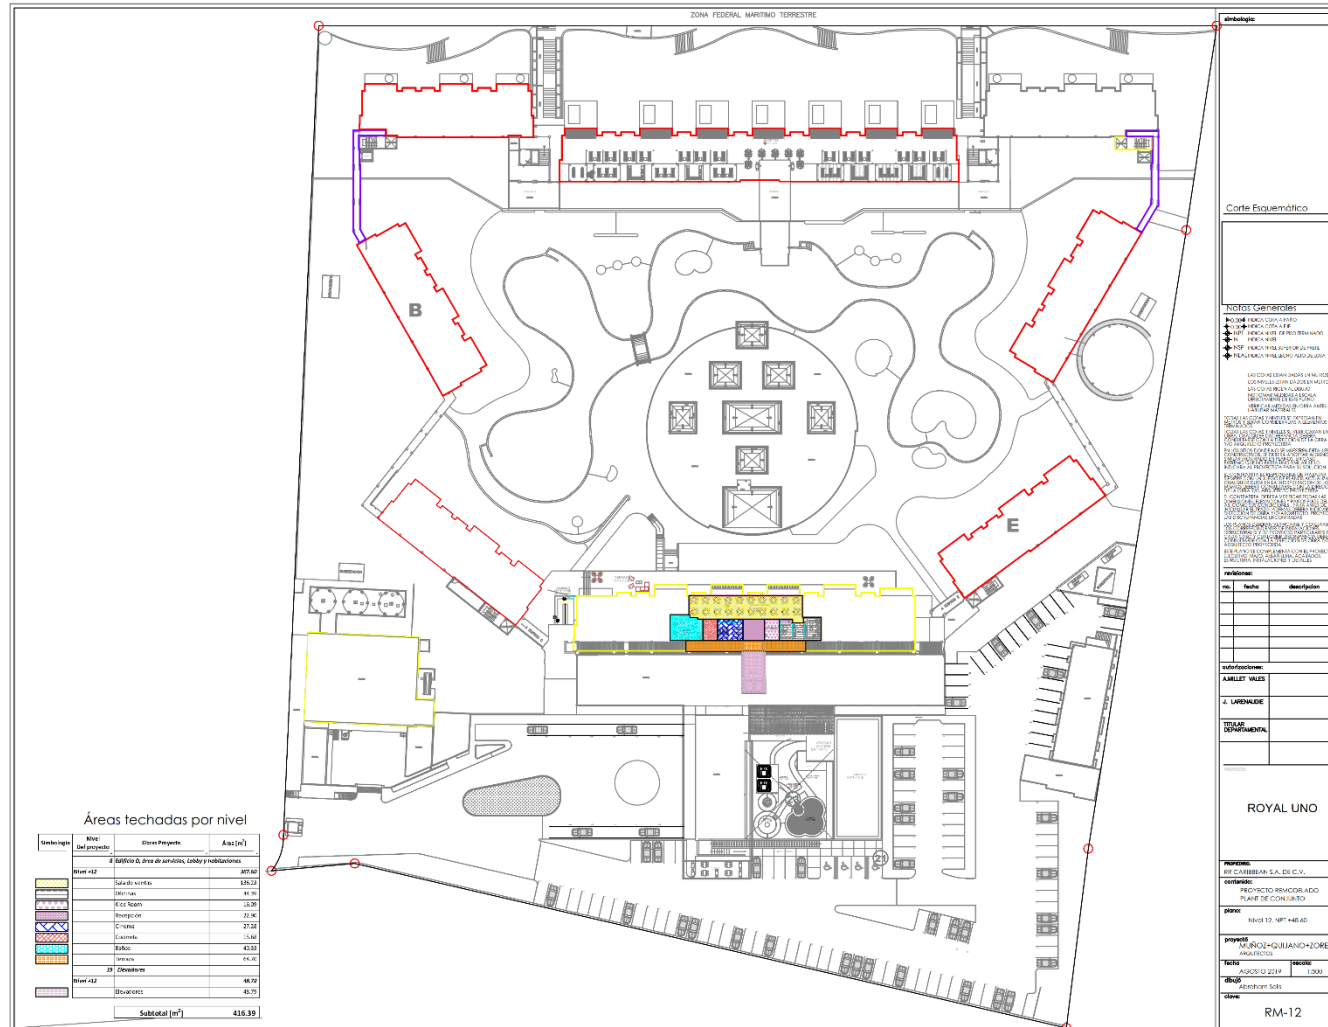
Proyecto remodelado, obras nivel 12. Anexo C-6.
